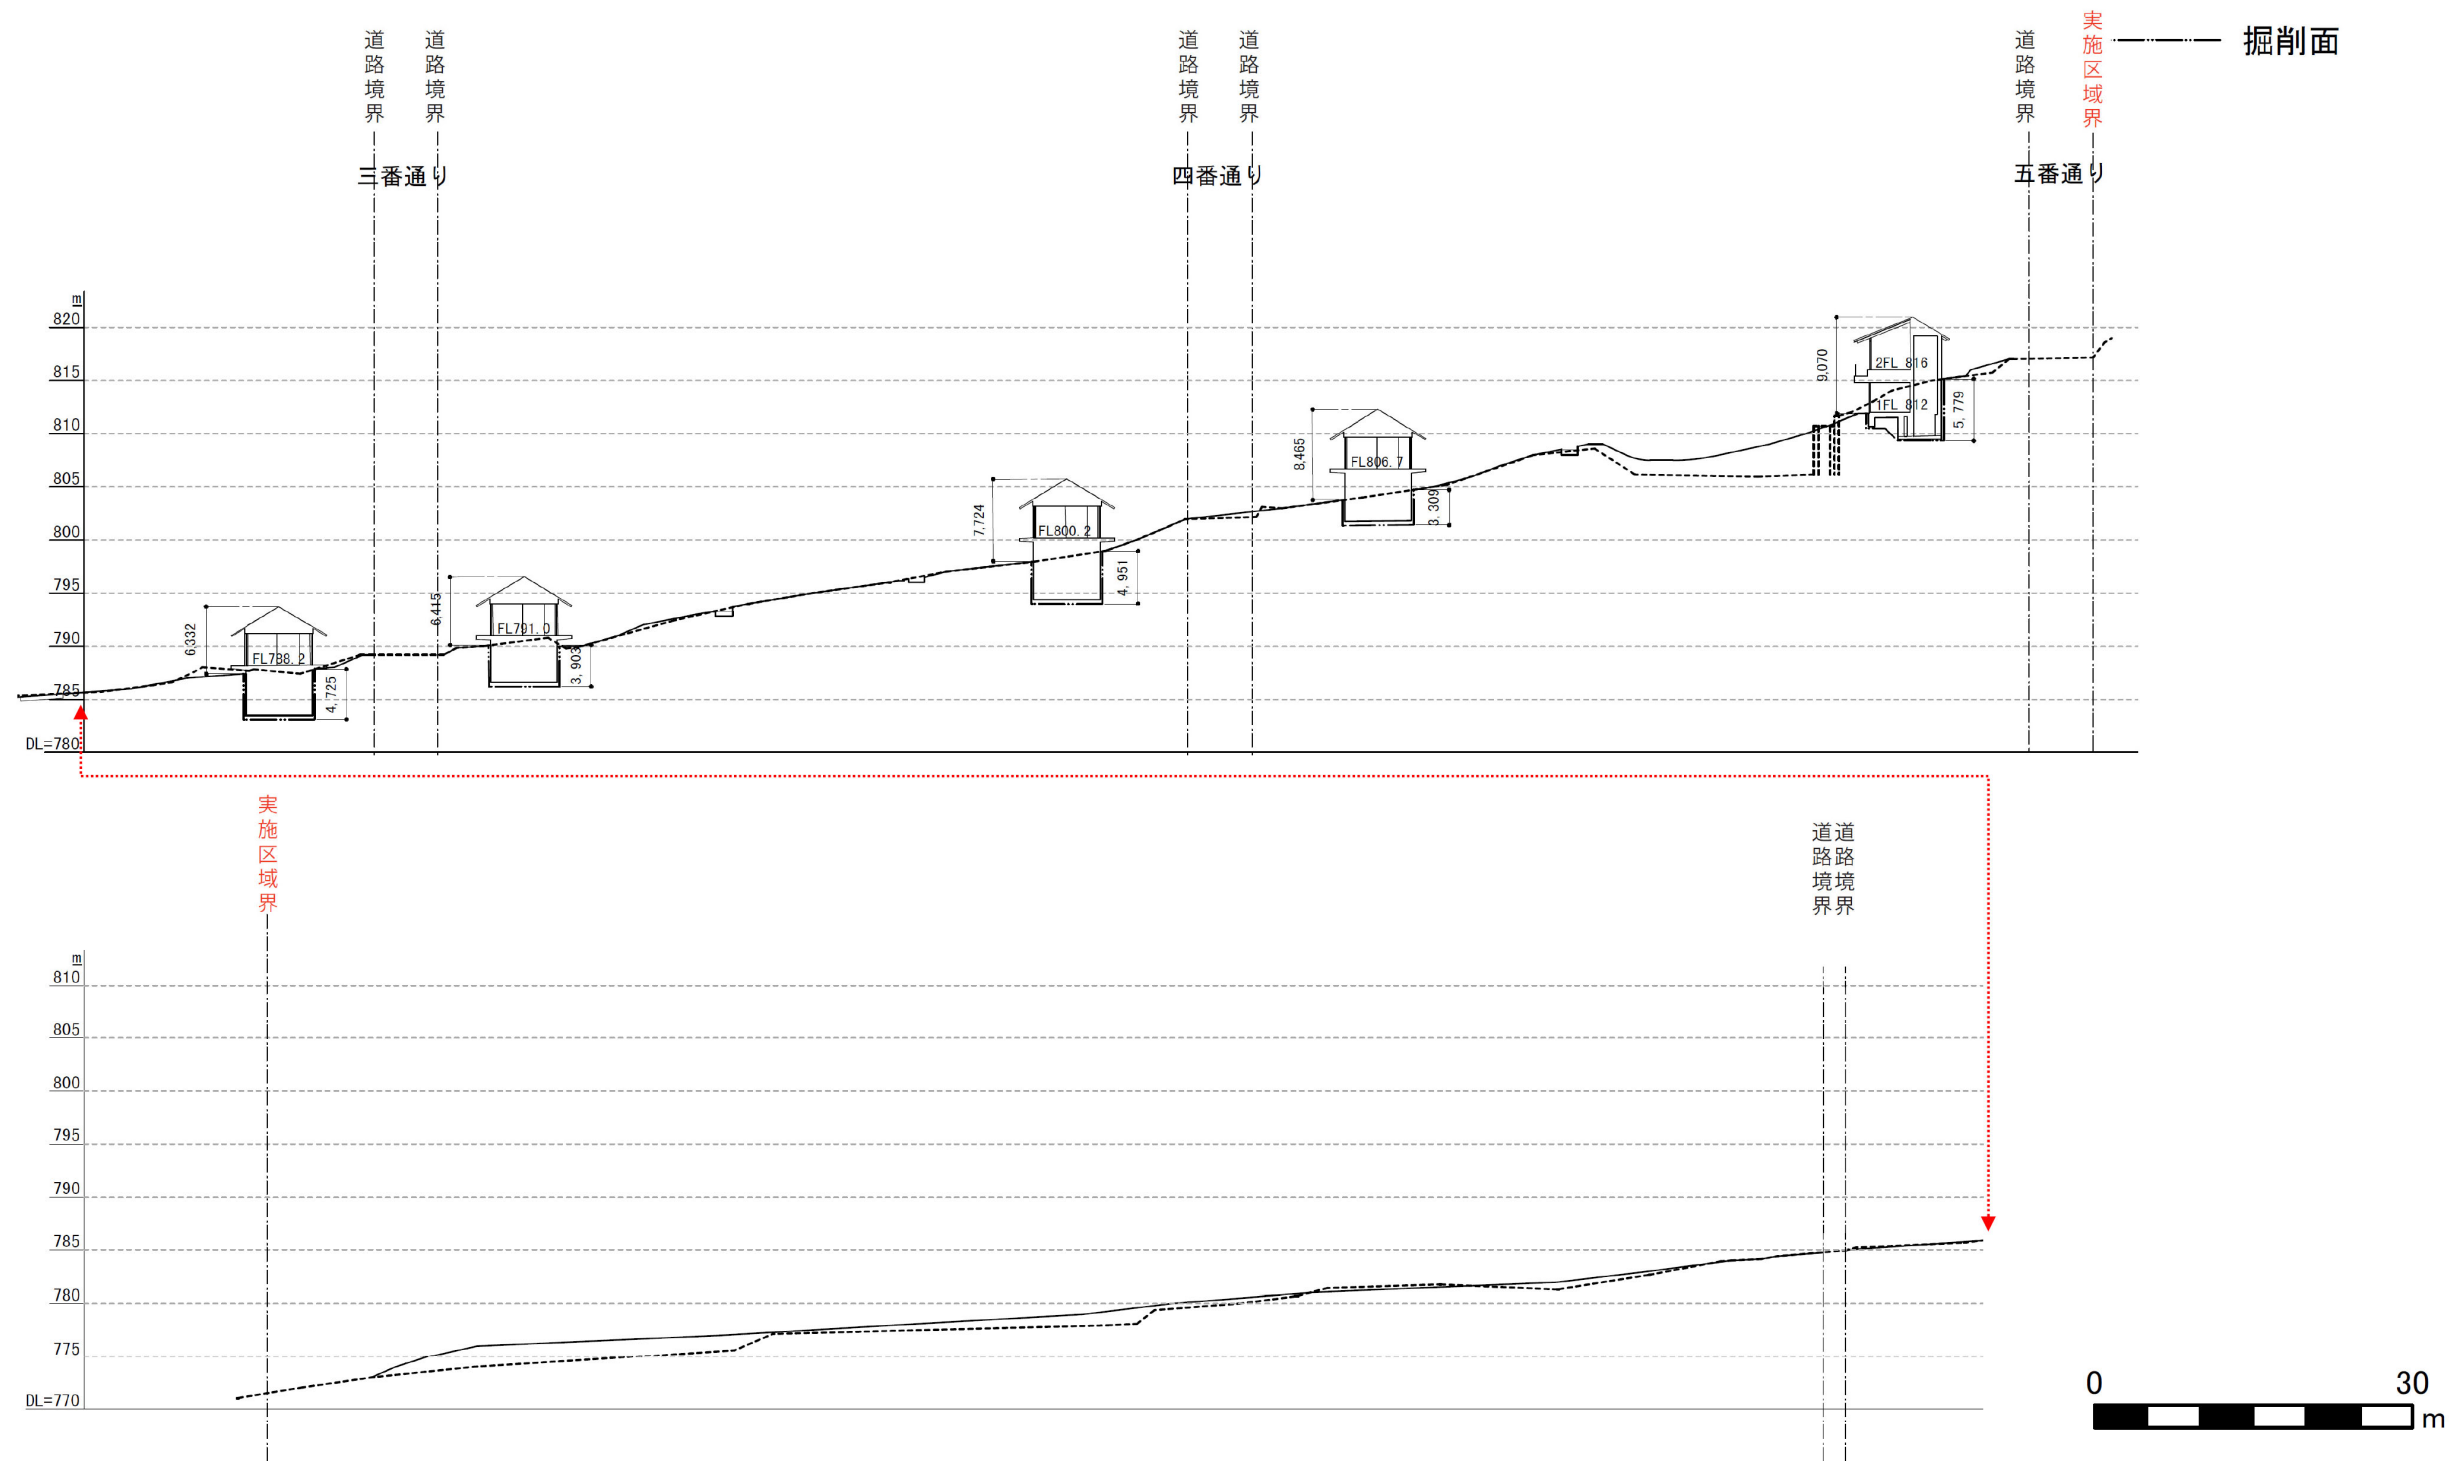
施設配置図 (縦断面) (1/2)
